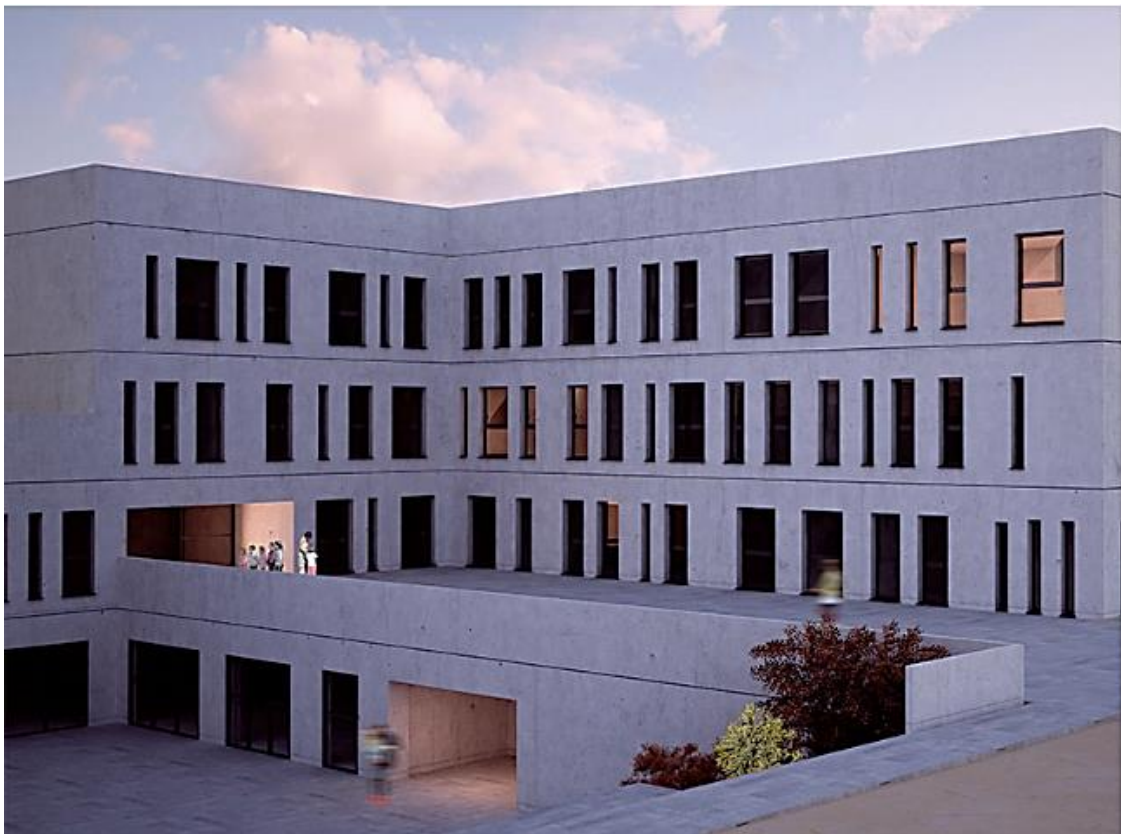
Vista de la fachada de hormigón prefabricado blanco.
